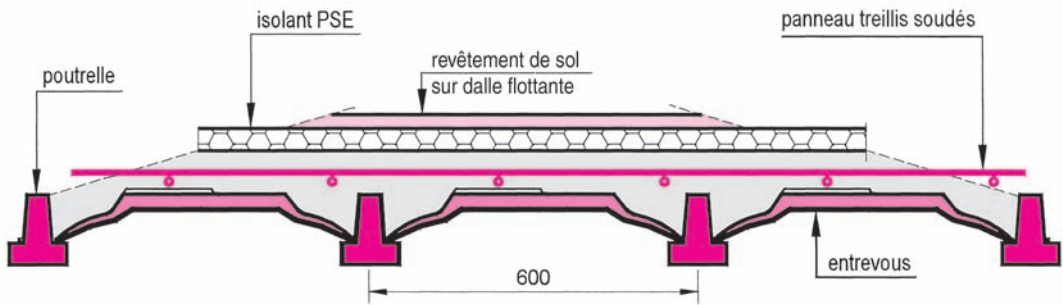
Plancher sur vide sanitaire avec dalle flottante sur isolant PSE ou polyuréthane
